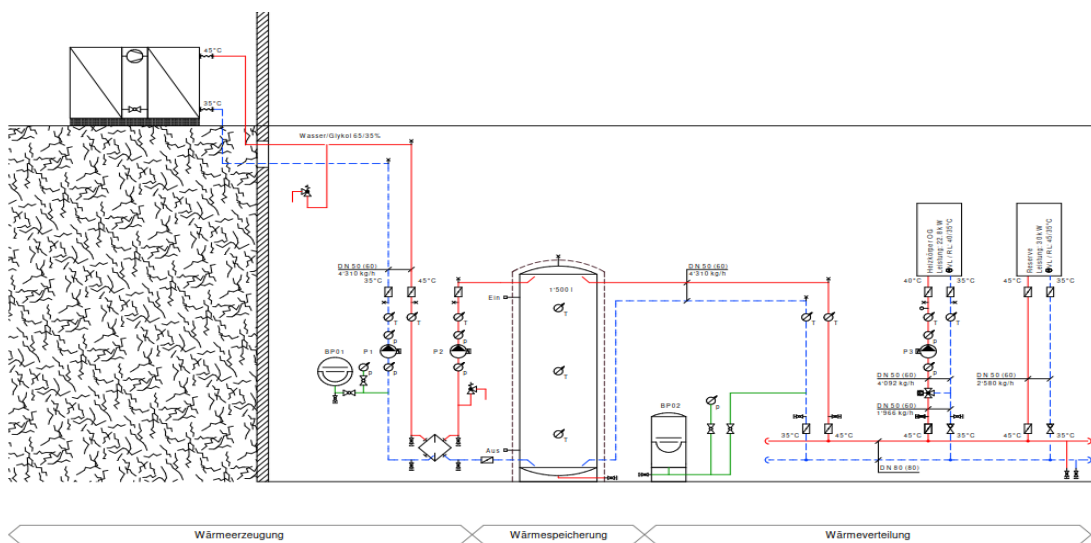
Prinzipschema Heizung. Quelle: Ing. Büro Brunner Haustechnik AG, Wallisellen
